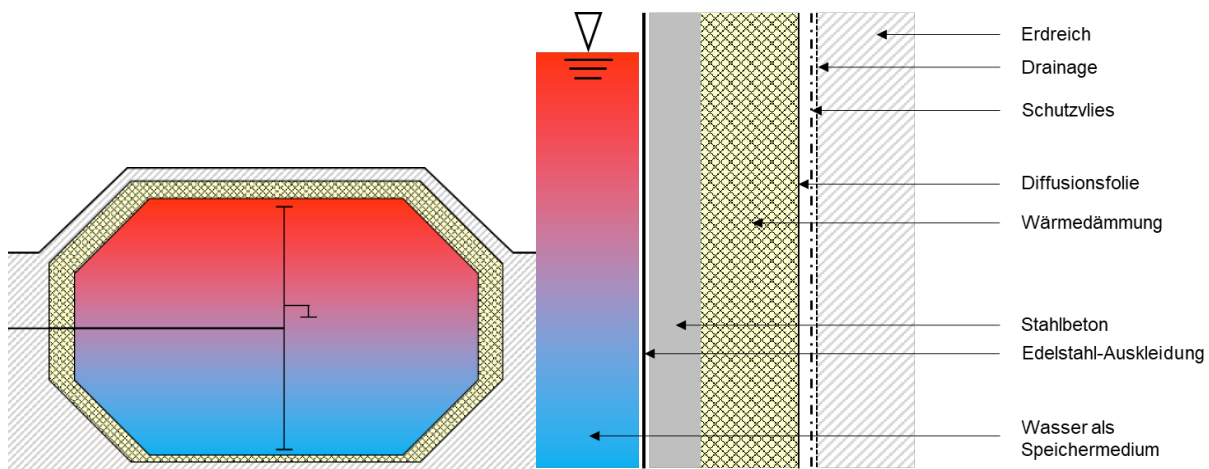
Schema eines erdvergrabenen Betontanks (links) und dessen Wandaufbau (rechts).
